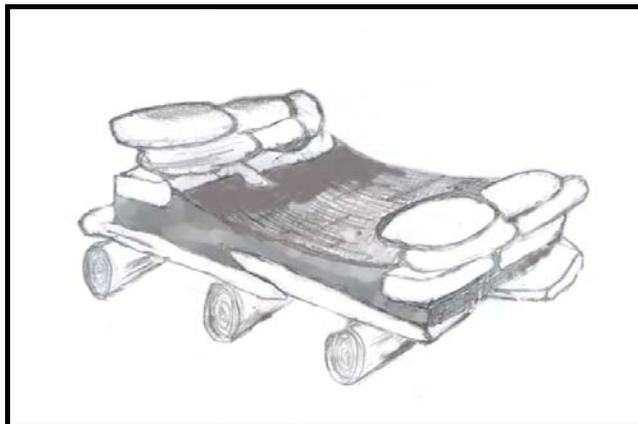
Puente construido con vigas de castaño, lajas, piedras, tierra y tarquín (Dibujo por cortesía de Cano-Manuel y del Grupo Tragsa de Granada).
